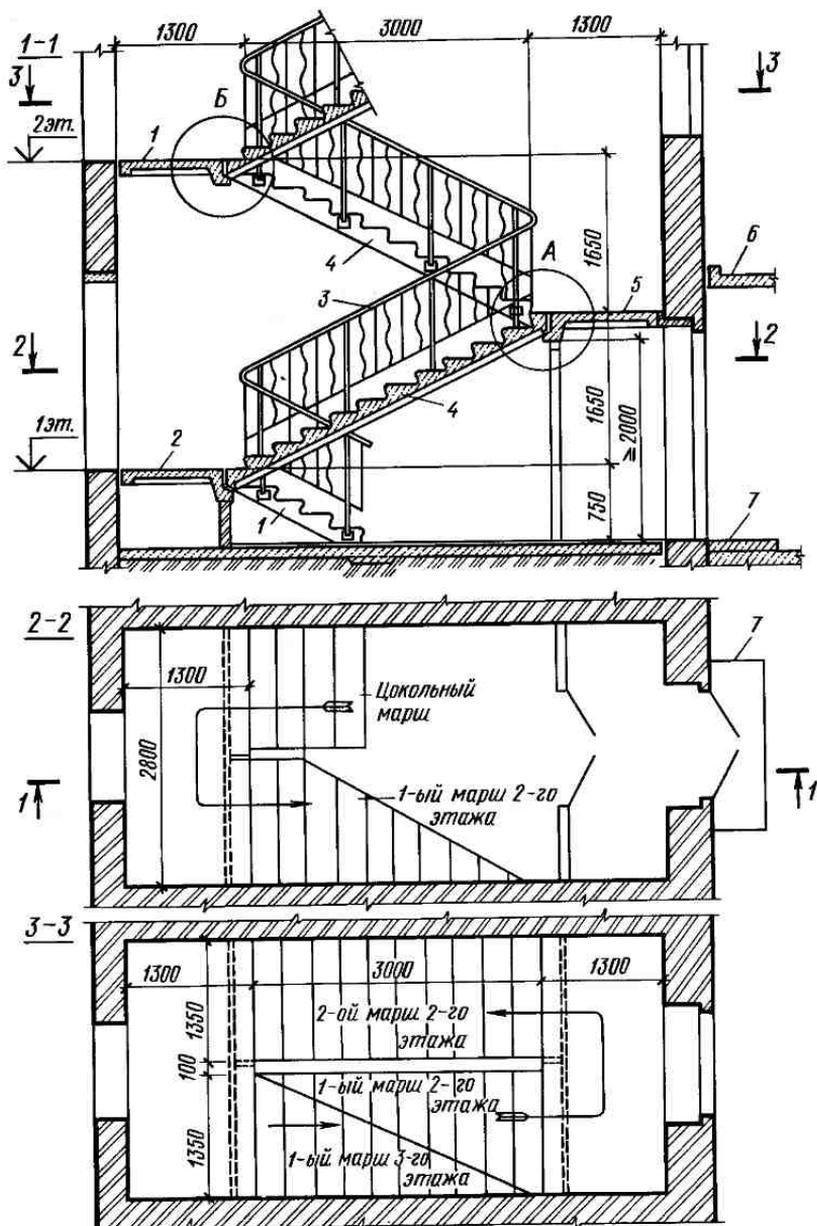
Двухмаршевая лестница (разрез и поэтажные планы):
